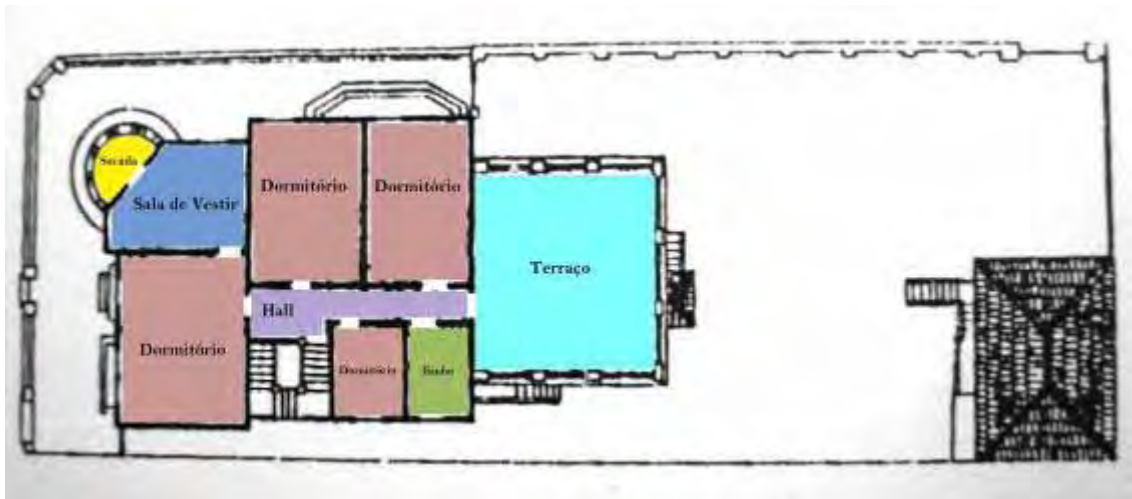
Planta Palacete Camilo de Mattos, obra de Antônio Soares Romêo, 2º pavimento.
